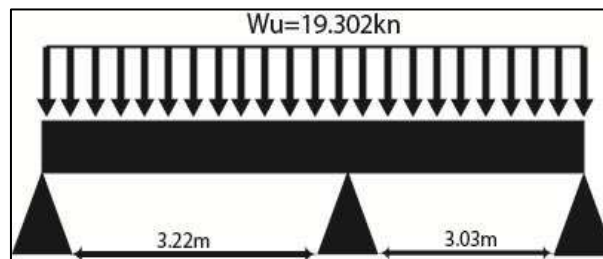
Carga distribuida entre apoyos; Fuente: [Grupo investigador]
